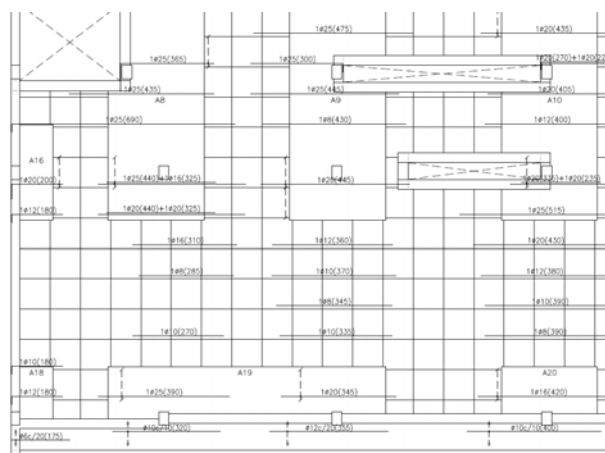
Armadura longitudinal superior necesaria previamente a la intervención
